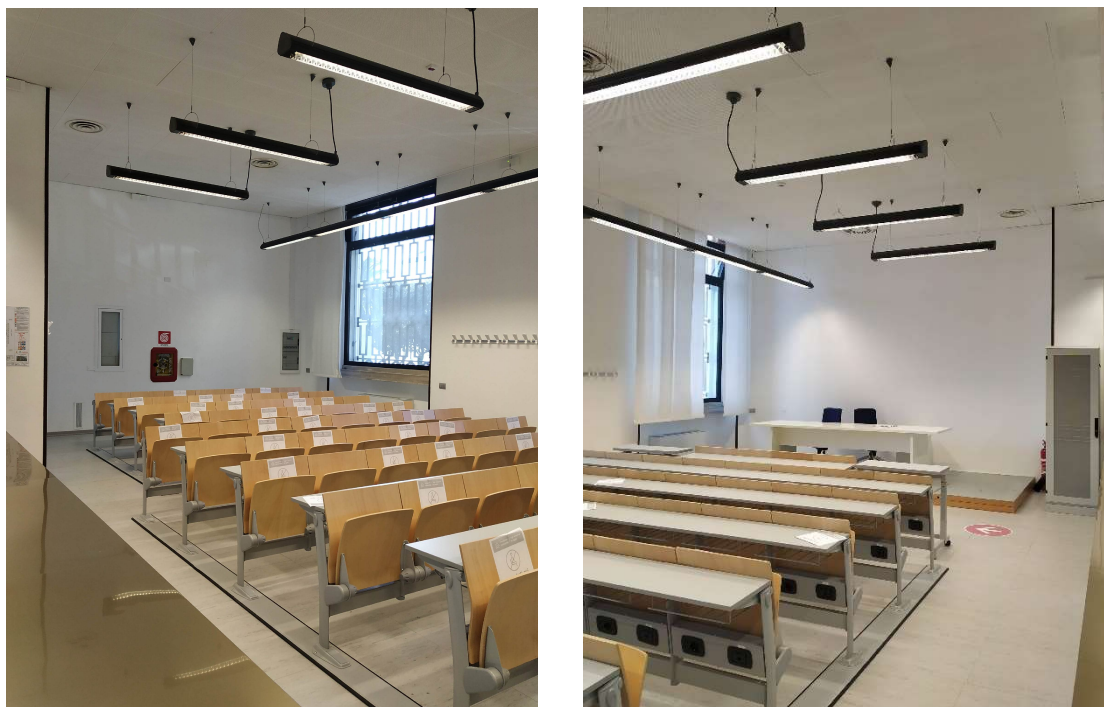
Foto banchi installati all'interno del "Progetto di allestimento della scuola di medicina e chirurgia nella sede ex banca d'Italia - I lotto funzionale"
